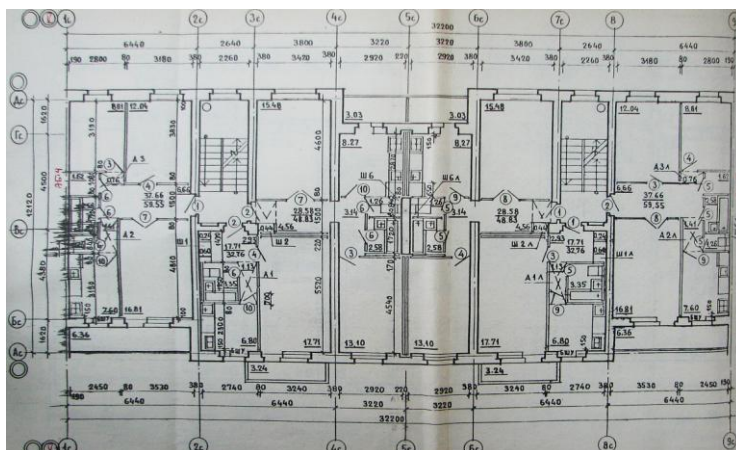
Рядовая блок-секция 85-04. План типового этажа жилого дома по ул. Королева, д. 7Б
